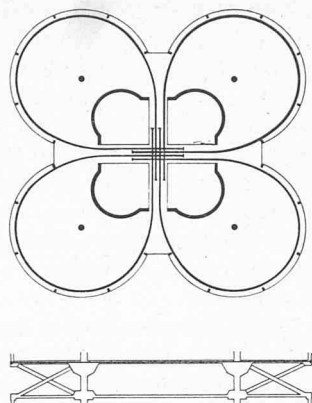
Technikgeschoss. Spannbewehrungsschema der Zugdecke
